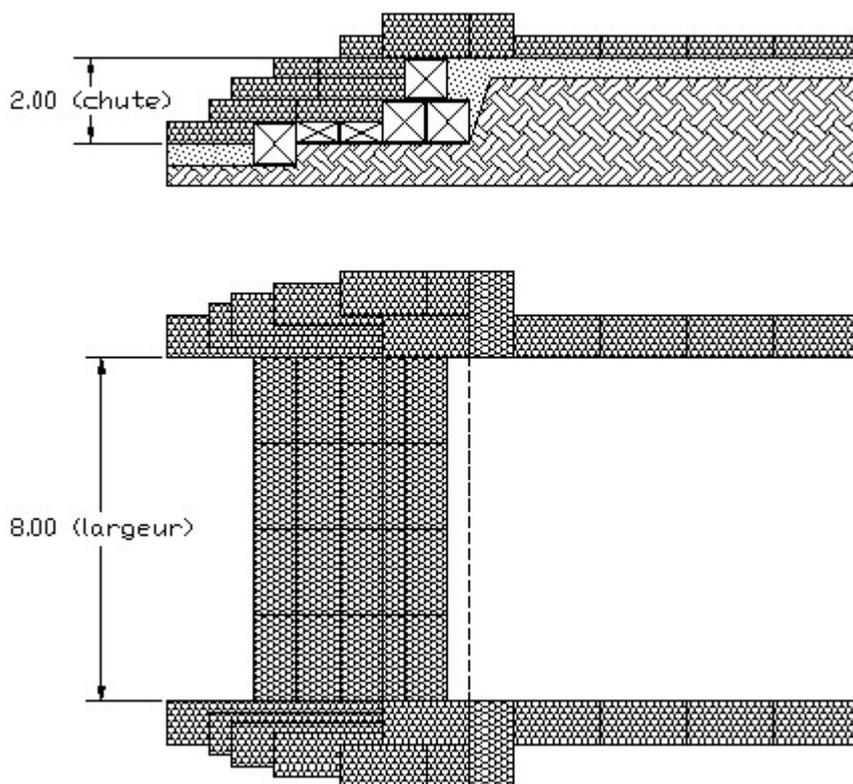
Plan et coupe transversale d'un seuil en gabions
